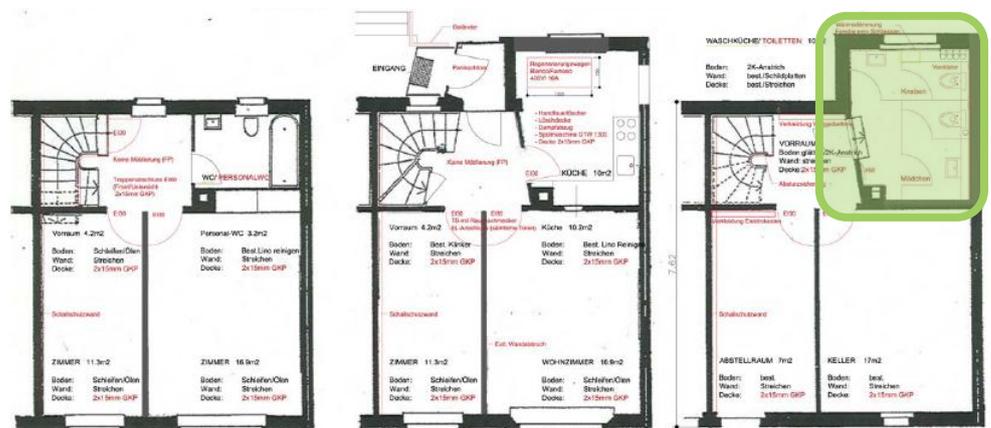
Grundrisse Hort Arbentalstrasse (Zürich)
